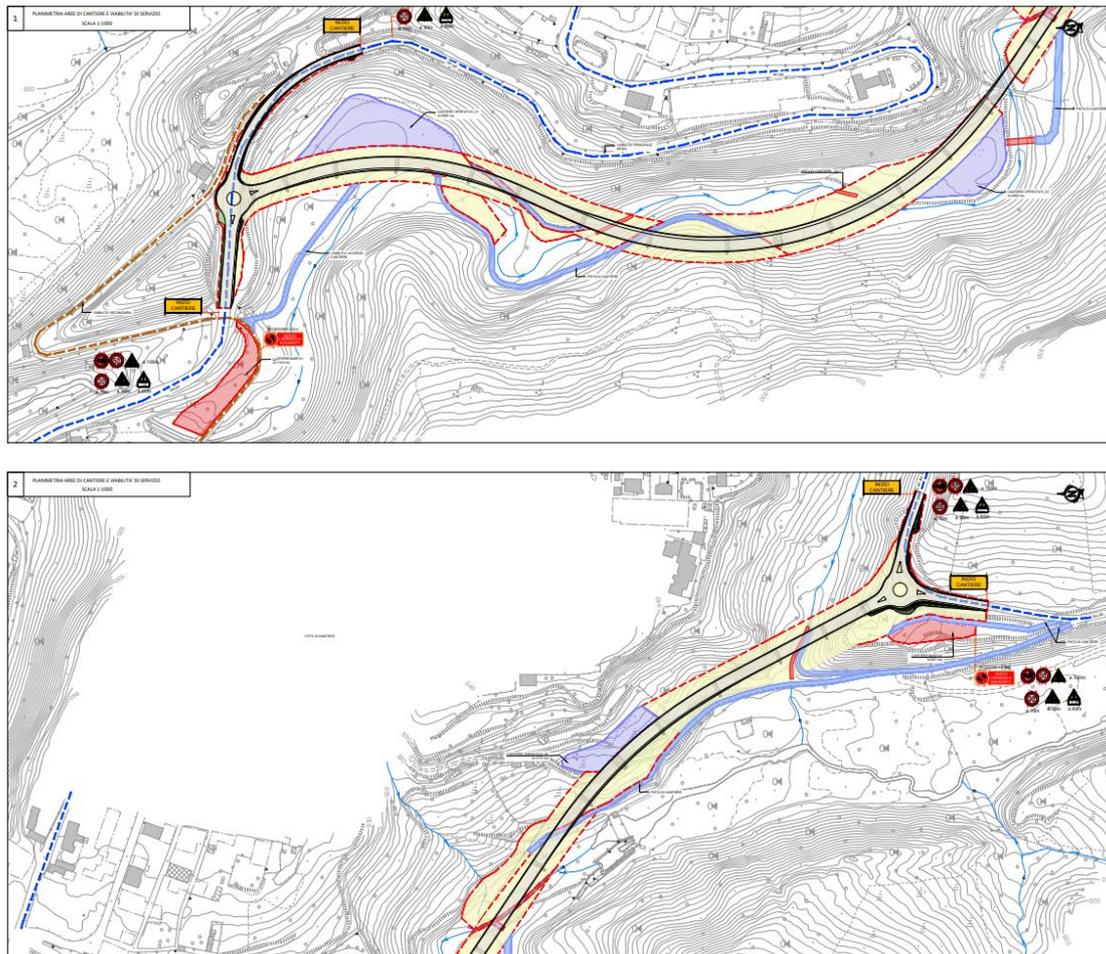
Planimetrie aree di cantiere e viabilità di servizio
